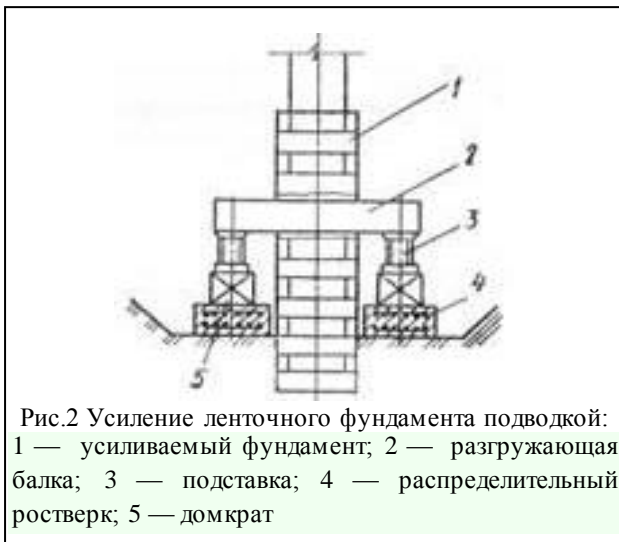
Усиление ленточного фундамента подводкой: 1 — усиливаемый фундамент; 2 — разгружающая балка; 3 — подставка; 4 — распределительный ростверк; 5 — домкрат
